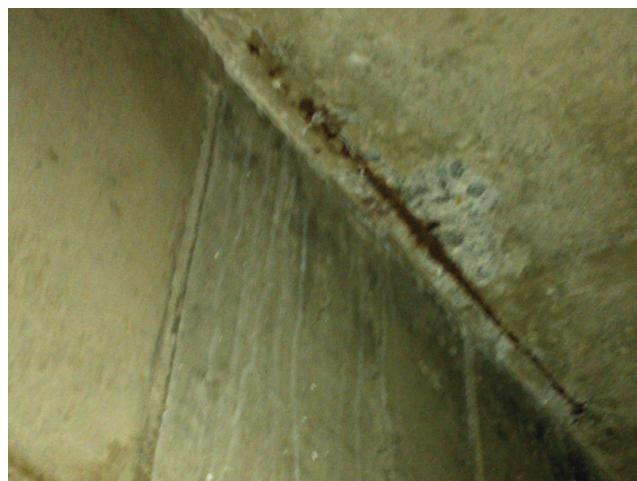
a— Viga localizada atrás do hall dos elevadores
